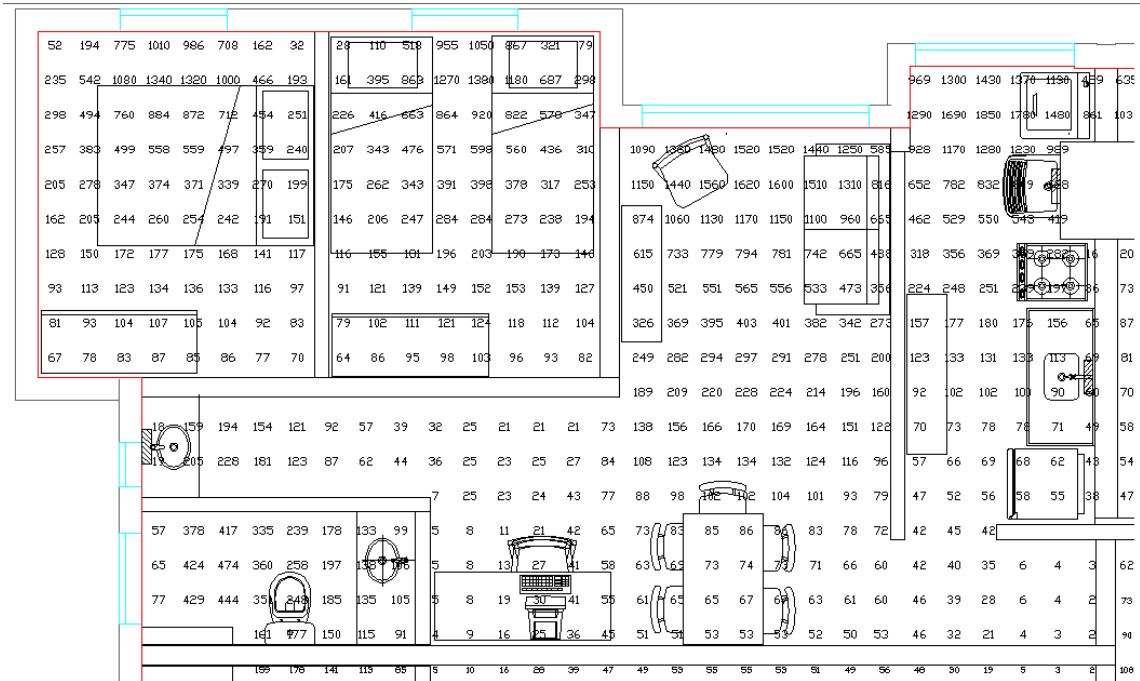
Distribuição da iluminância ponto a ponto no pavimento tipo (em lux).
